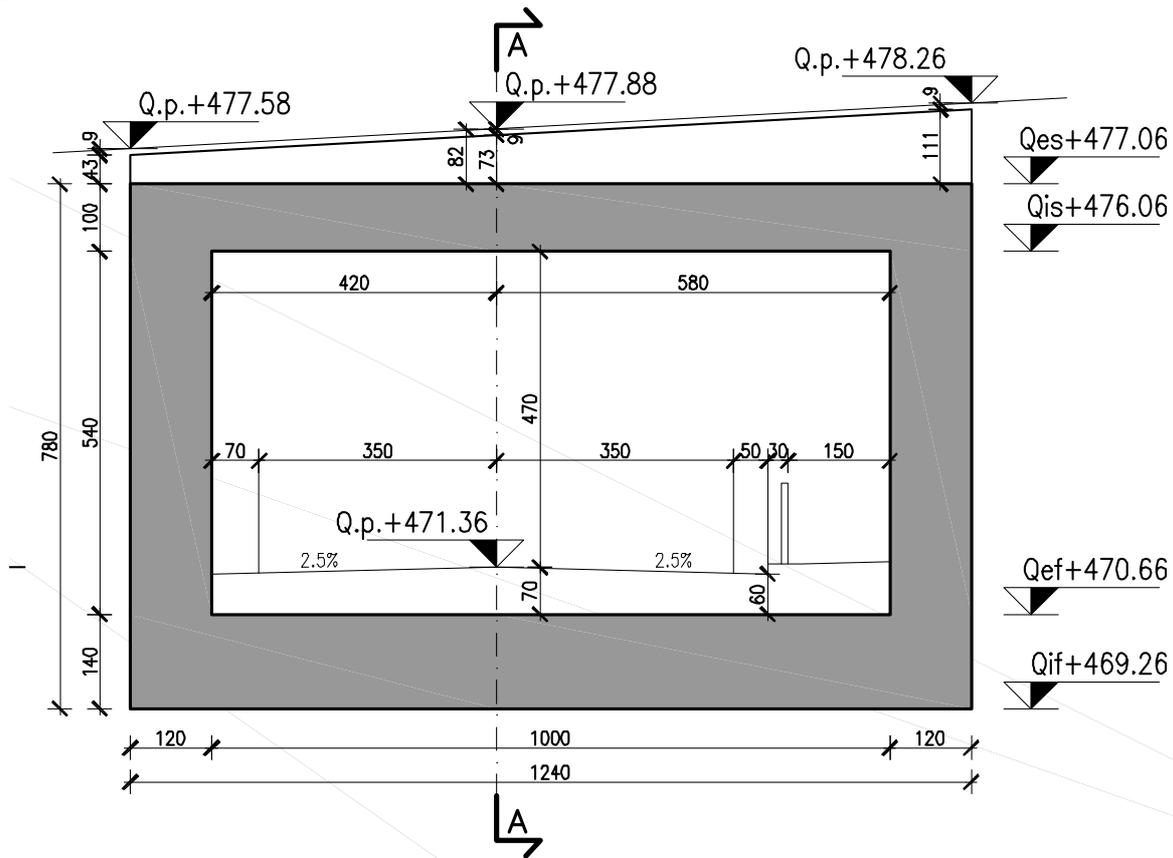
Sezione trasversale sottopasso di cantiere SP 24
